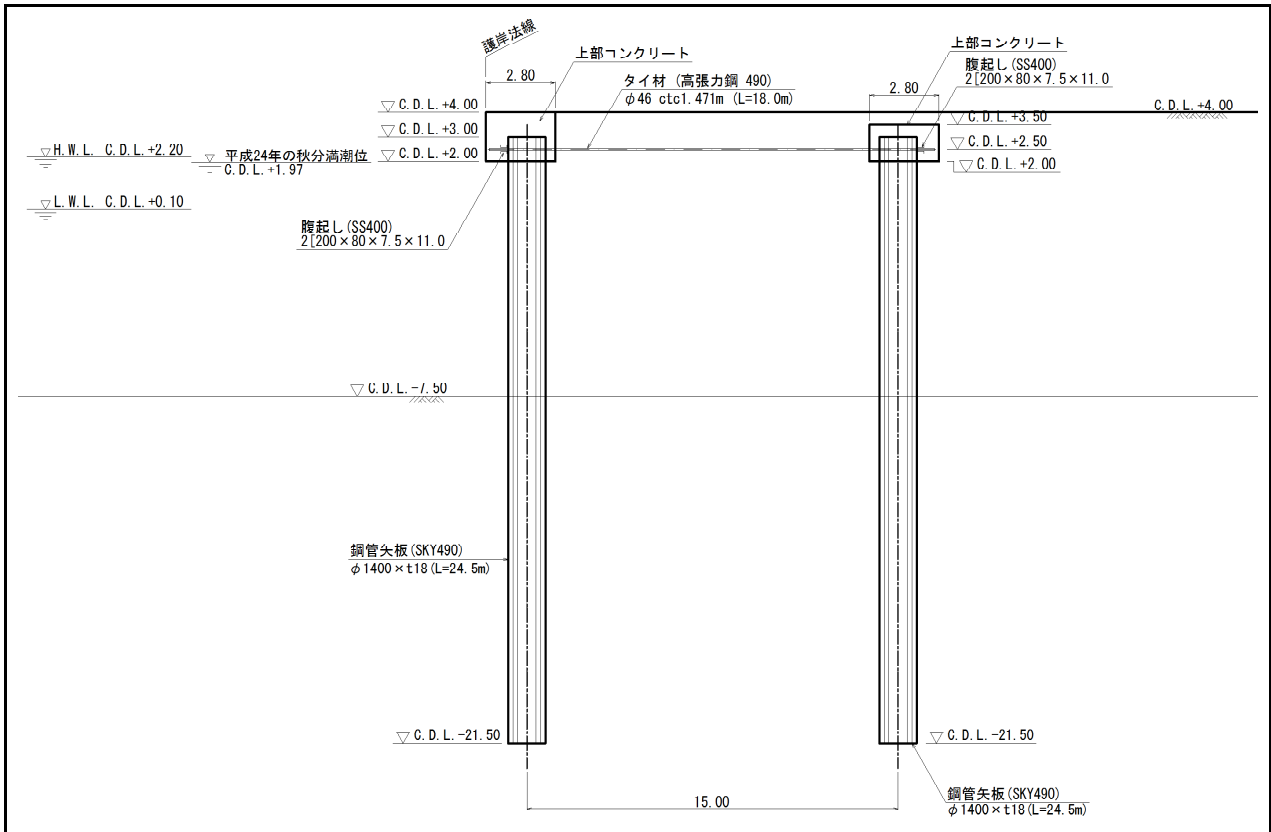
中仕切岸壁B (-7.5m) 標準断面図
